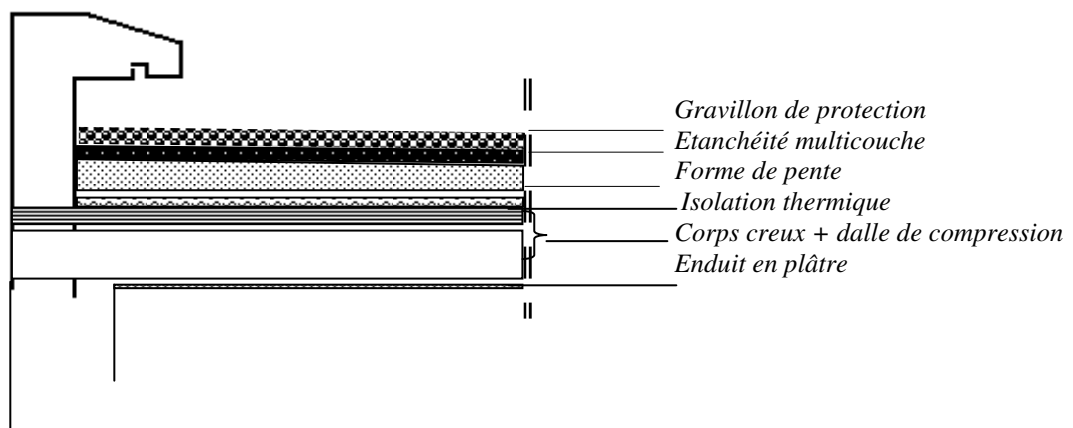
a.: Coupe transversale d'un plancher terrasse
